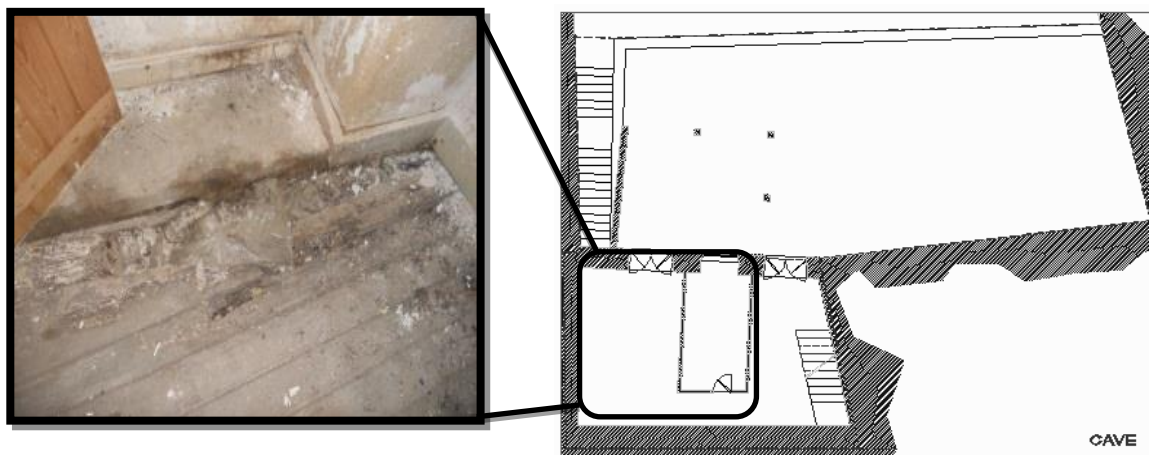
Anomalia 2 - Fotografia e localização em planta
